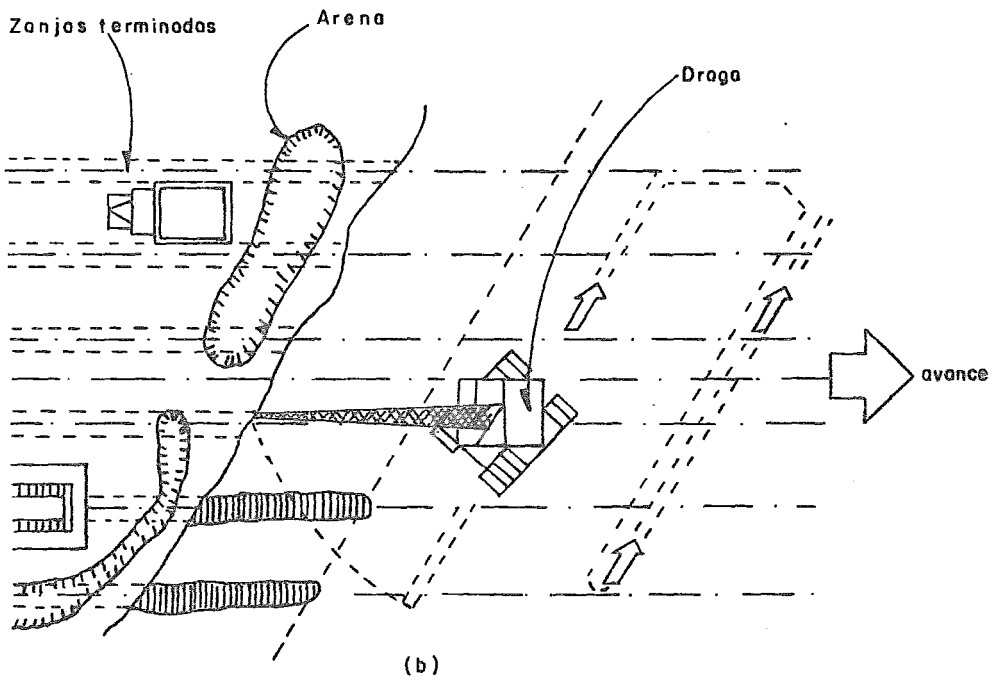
Construcción de trincheras drenantes (ref.14)
